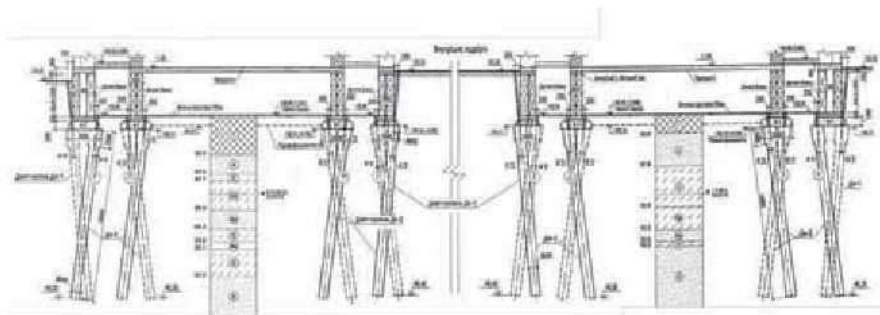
Поперечний розріз будівлі з розташуванням джет-палей.
